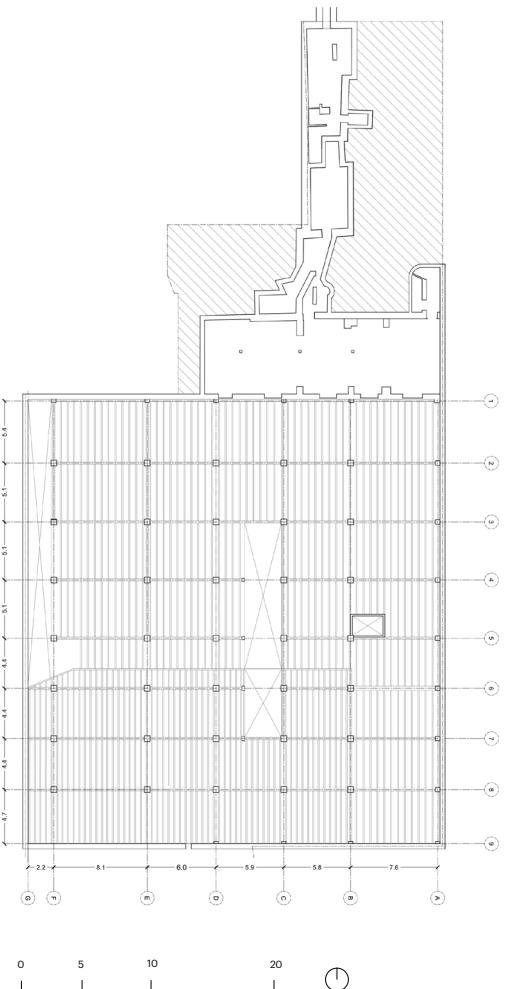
Plan de pose du plancher du rez-de-chaussée
